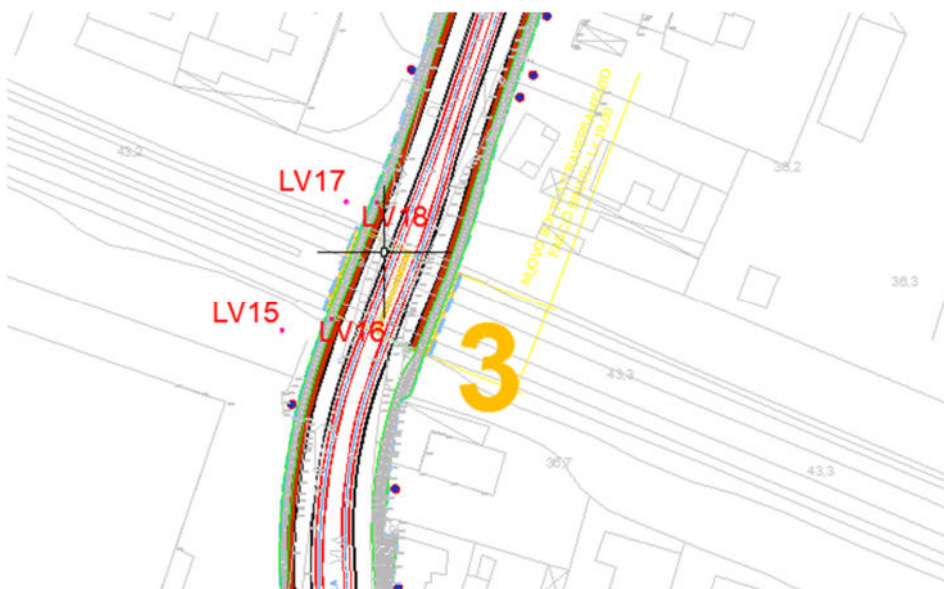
dettaglio planimetrico con il posizionamento dei carotaggi
